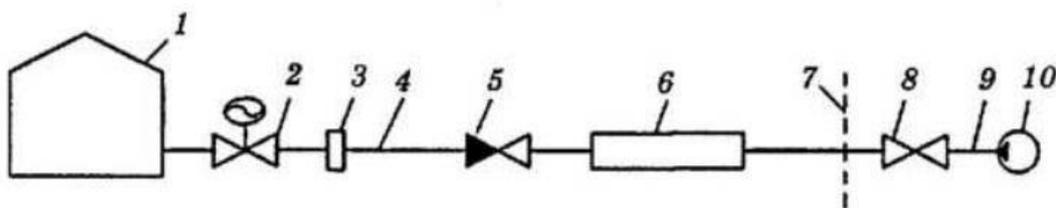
Схема підшарового гасіння пожежі: 1 – резервуар; 2 - засувка електроприводом; 3 - розривна мембрана; 4 - пінопровід; 5 - зворотний клапан; 6 - високонапірний піногенератор; 7 -
